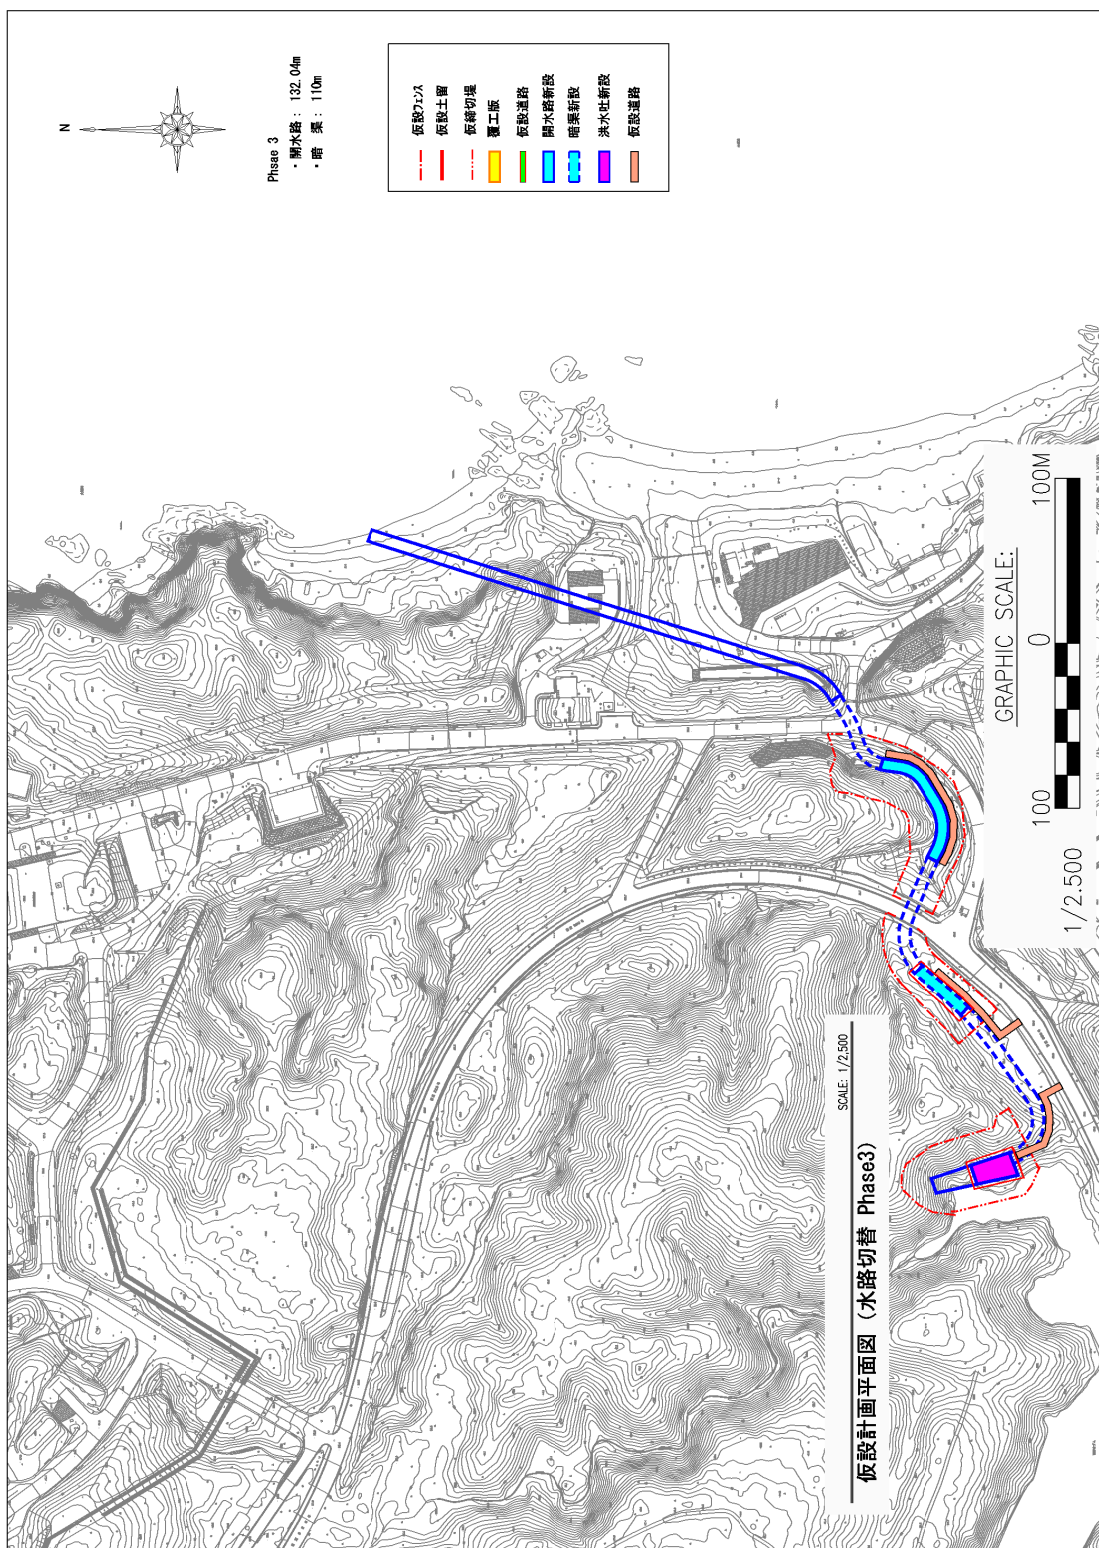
(3) 美謝川の切替え仮設計画平面図 (Phase3)
